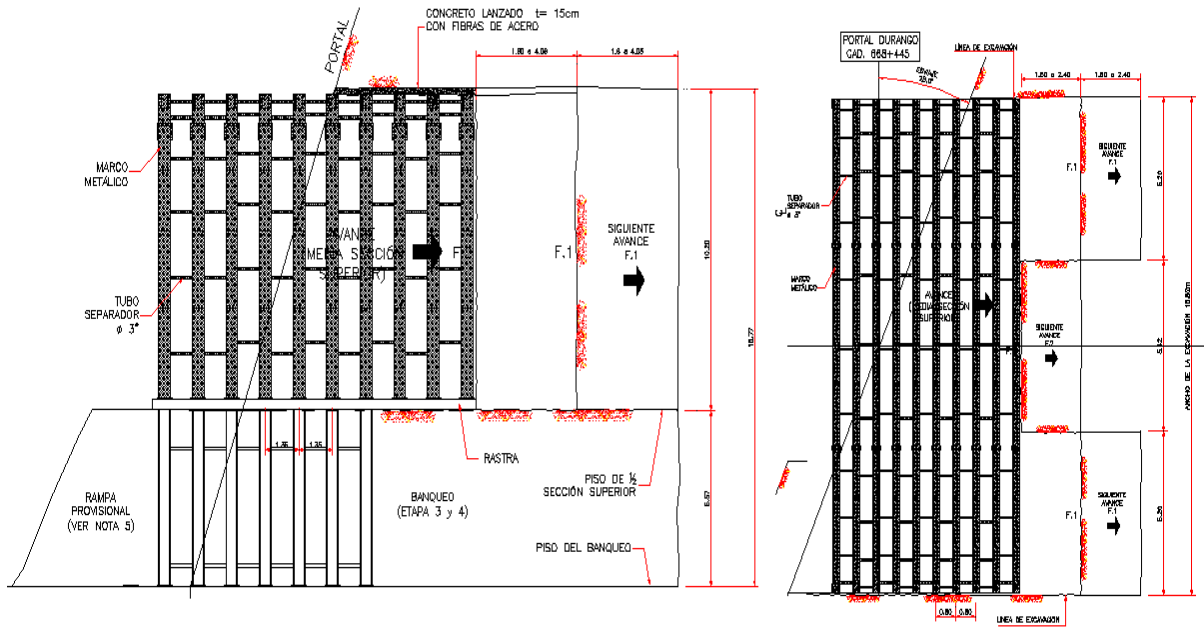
Perfiles y plantas de excavación en Condición Geotécnica “D(-)”
